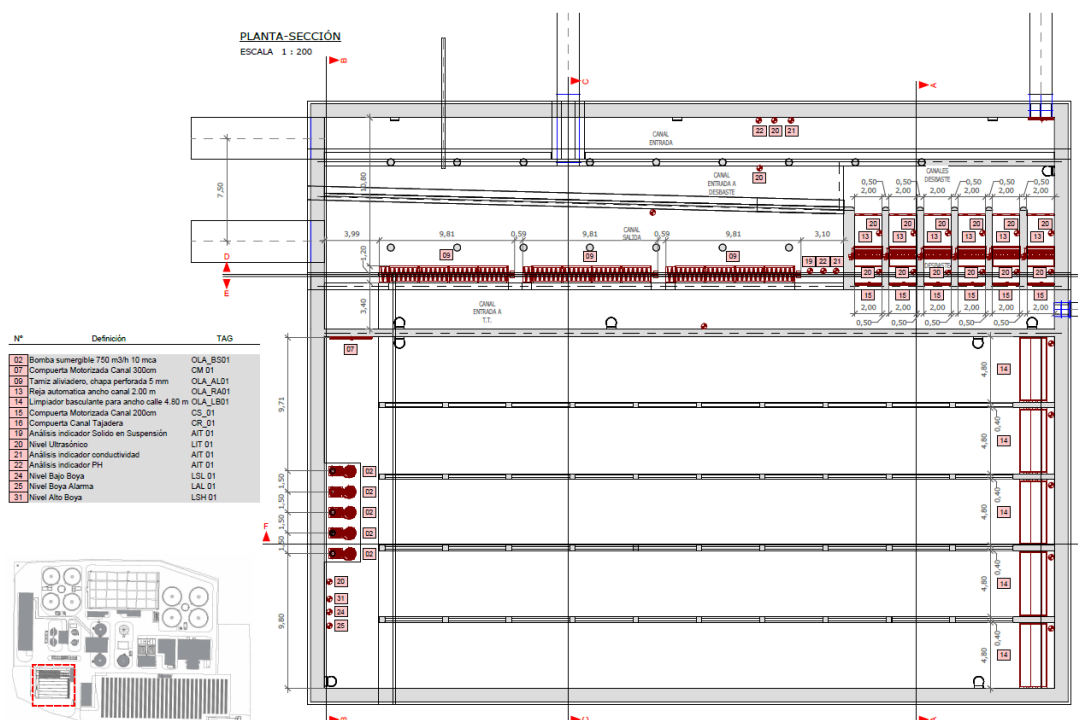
Planta general de obra de llegada, alivio y tanque de tormentas.
